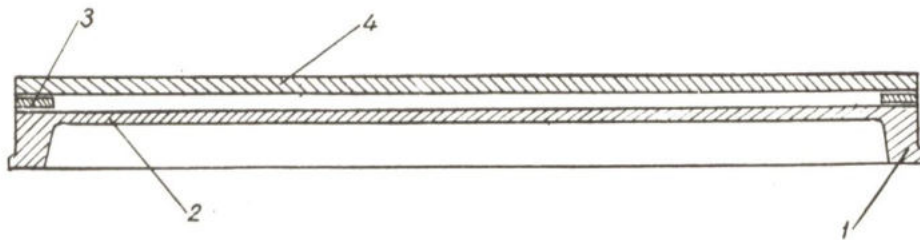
Конструкция пола из несущей деревянной плиты, опирающейся на продольные ребра шатровой плиты:
